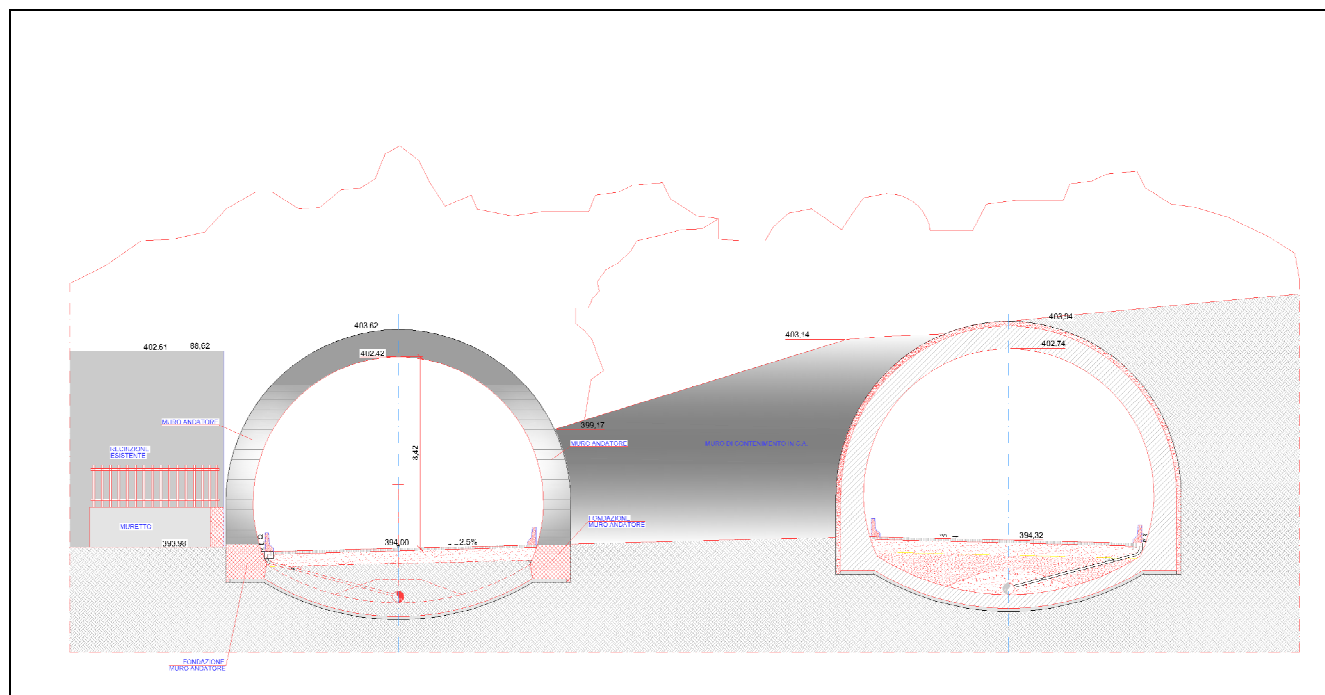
Sezione trasversale area di imbocco –lato Serino
